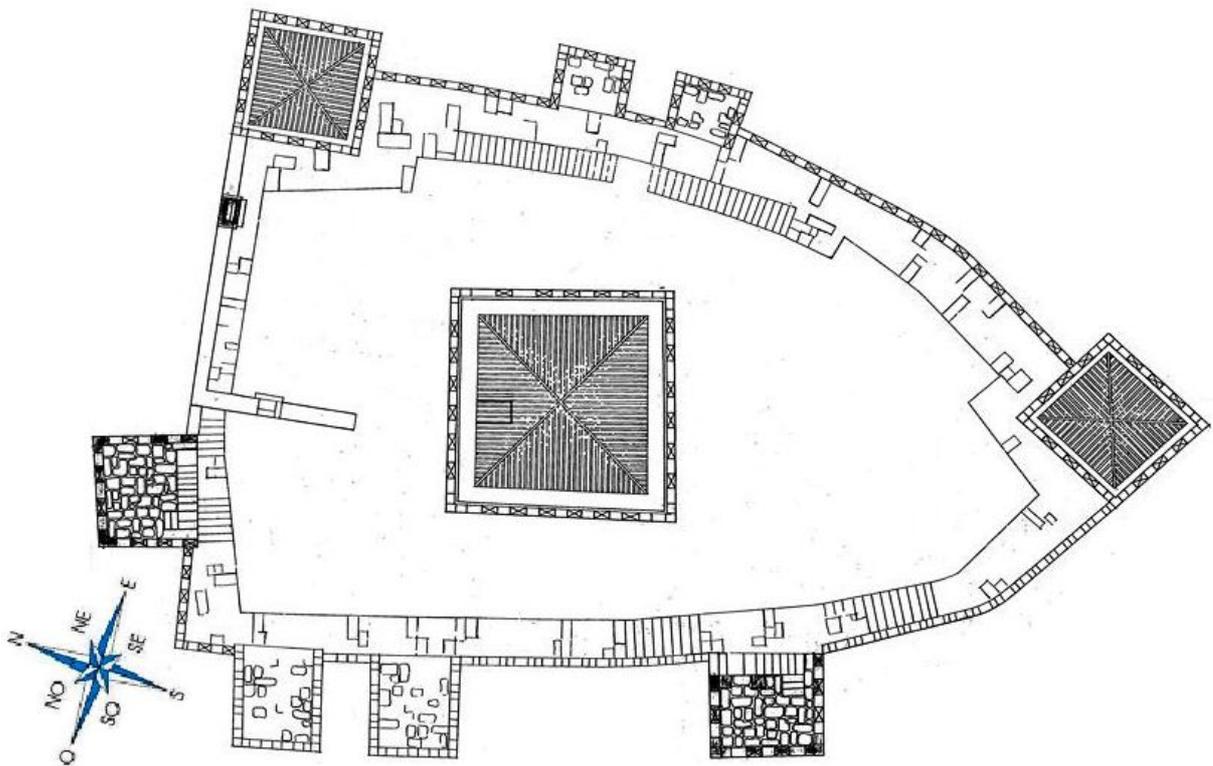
Planta do Castelo de Guimarães. Adaptada do site [31]
